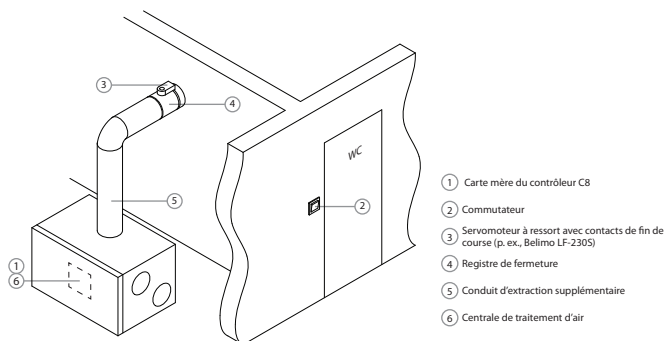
Exemple de montage d'un conduit d'extraction d'air supplémentaire
